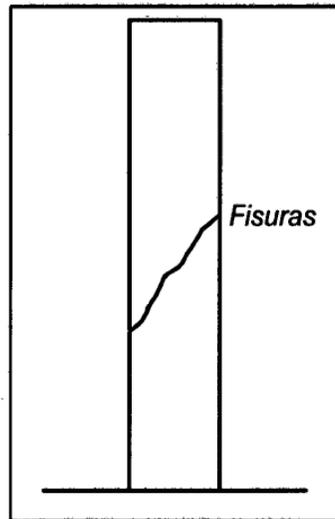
Fisuración inclinada en columnas por cortante
